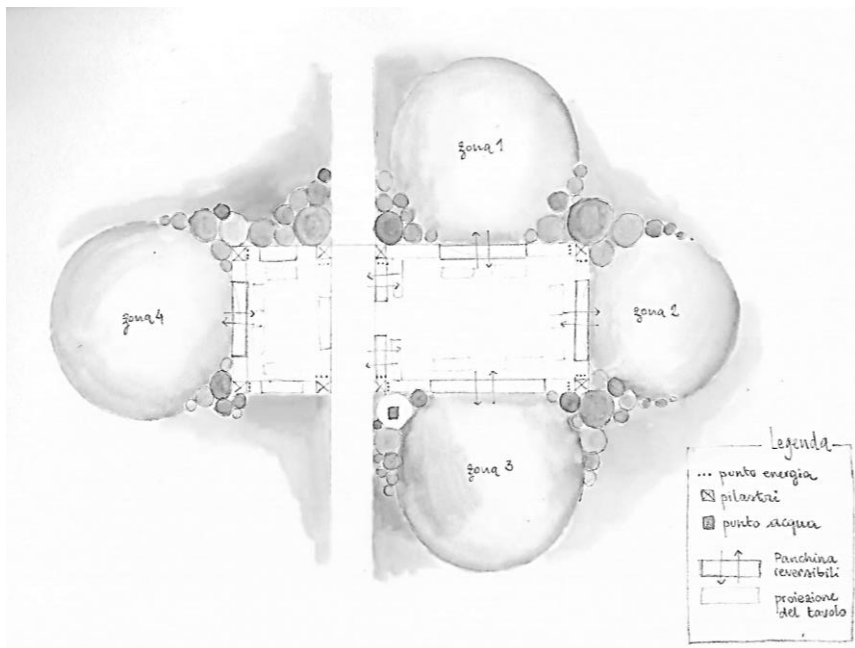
Pianta aerea dell'area con disposizione delle sedute e degli arbusti.
